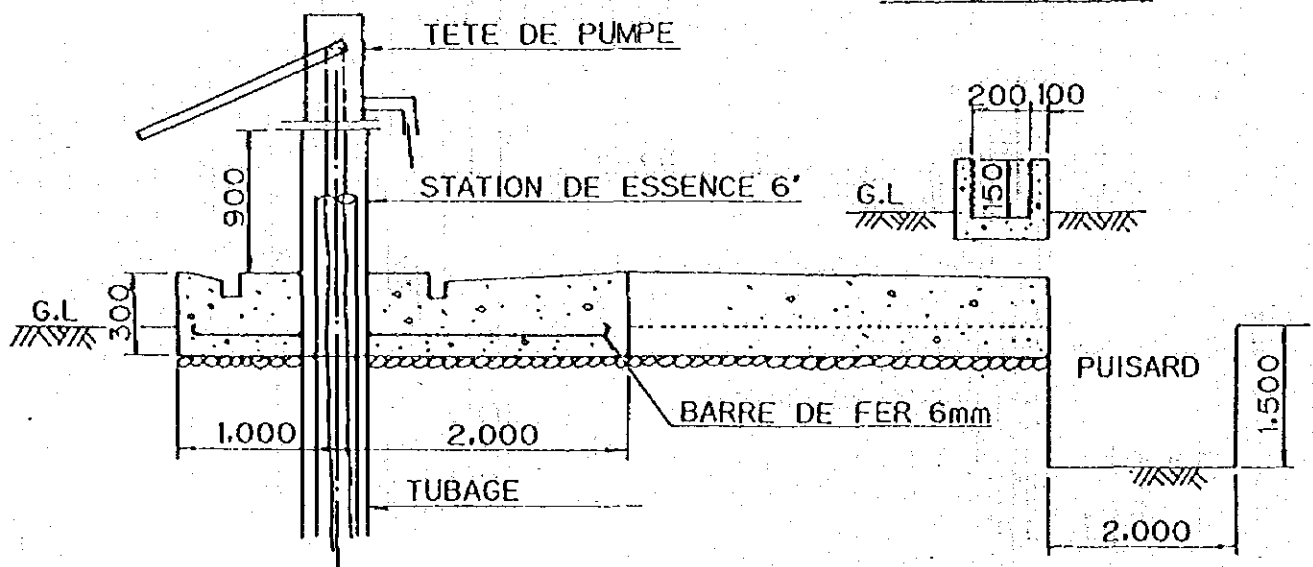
Structure standard d'une installation à pompe manuelle
